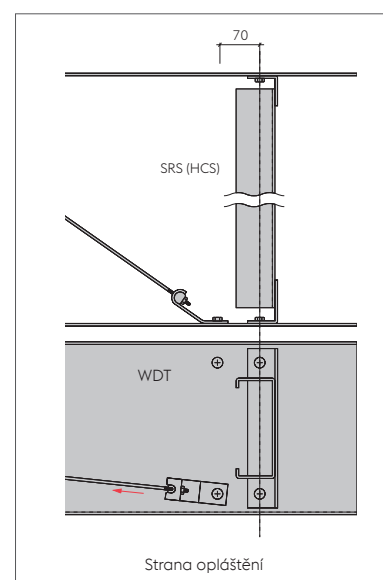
Detail konstrukčního uspořádání vyvěšení paždíkы pro rozpětí 6.10 – 10.00 metrů
